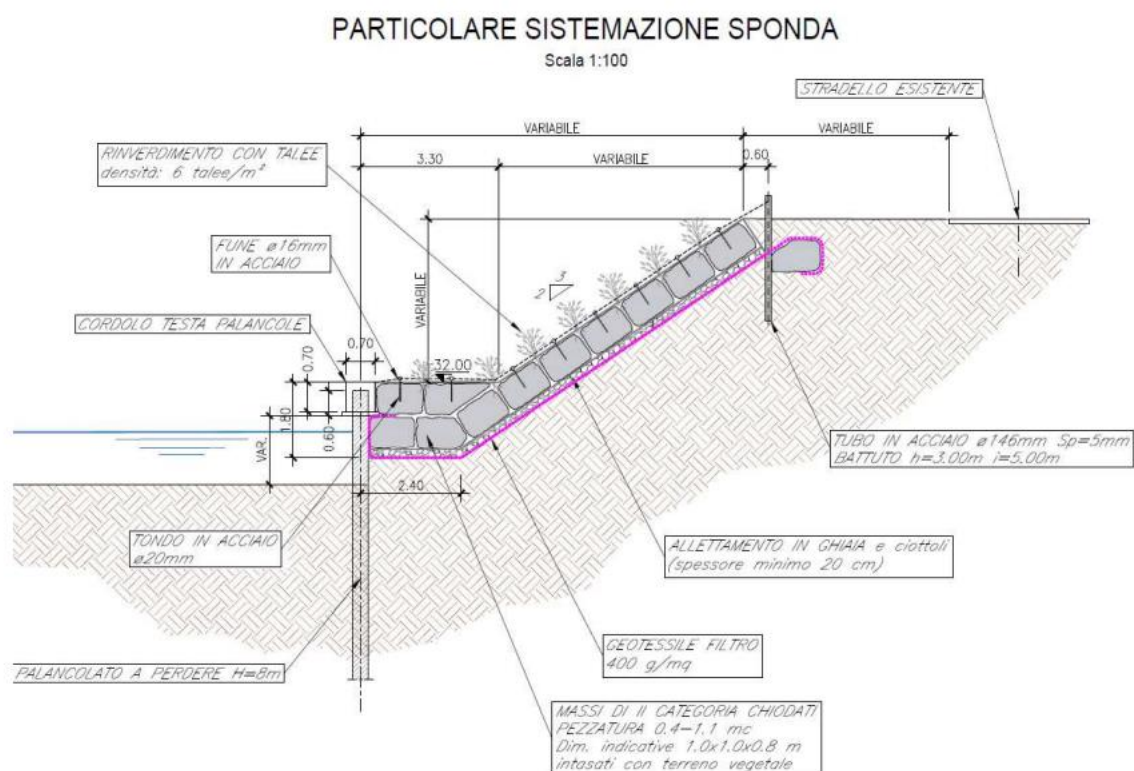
Sezione della sistemazione di progetto sulla sponda destra
